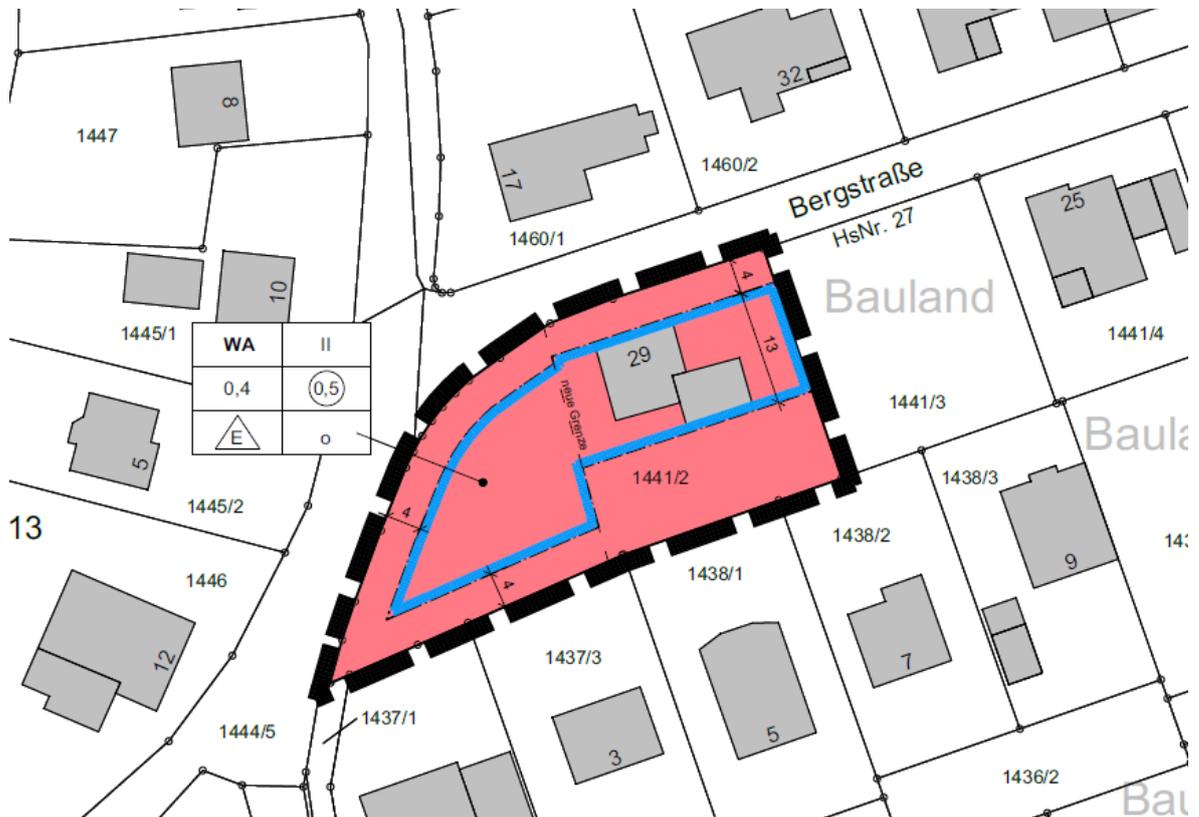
Auszug Bebauungsplan „Im Seelig, 5. Änderung“
